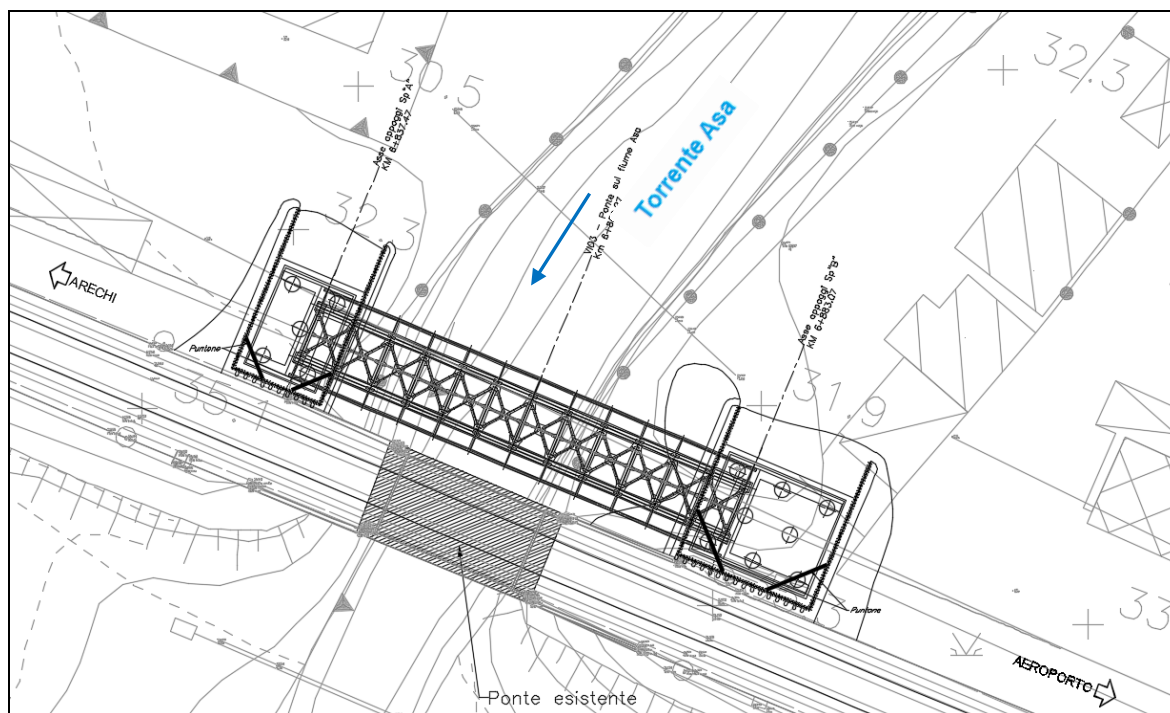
Viadotto VI03 sul Torrente Asa: pianta.
